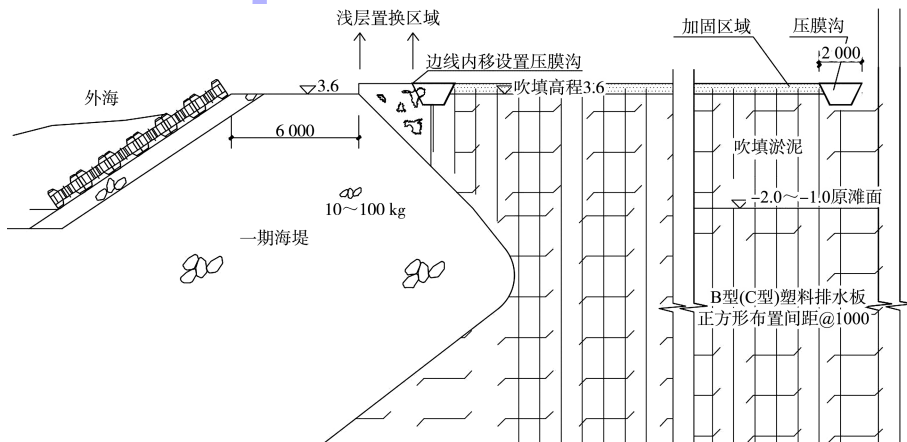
真空预压施工断面 (高程: m, 尺寸: mm)
